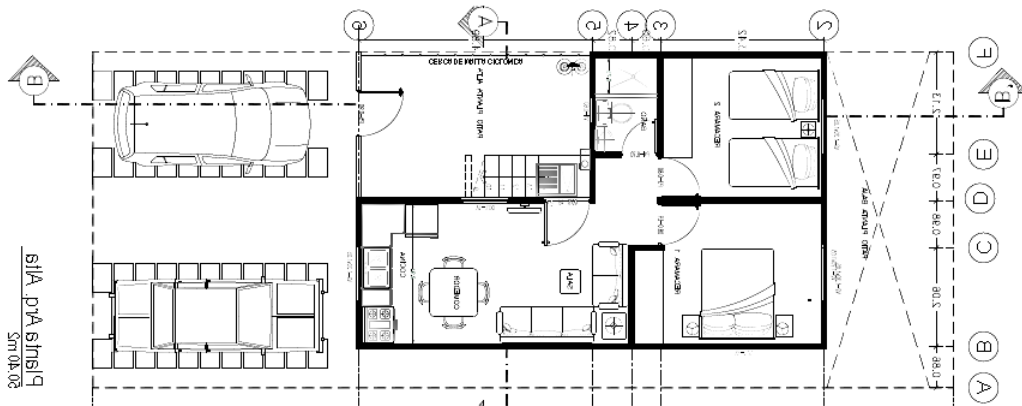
Planta alta arquitectónica del modelo verona plus, Fuente: Registro Único de Vivienda
